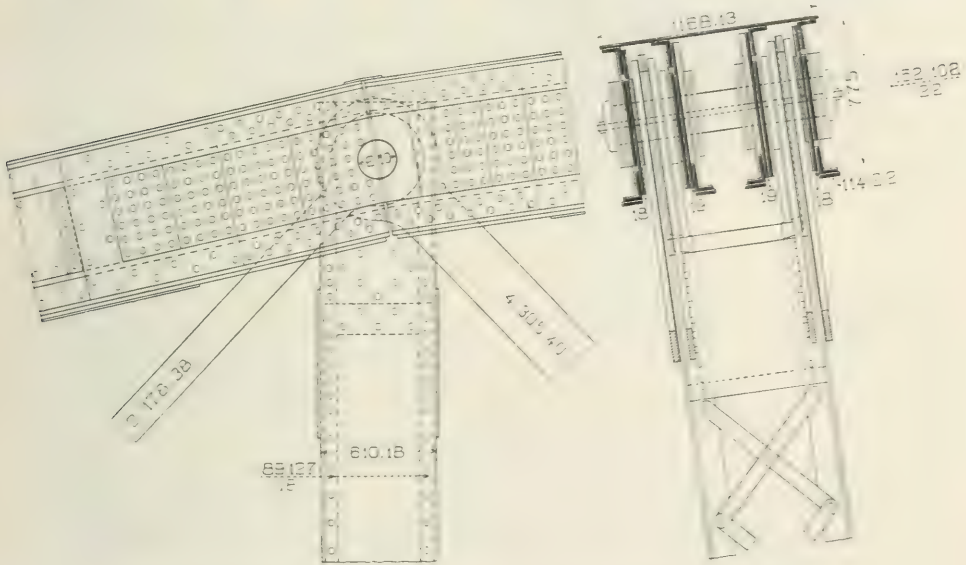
Obergurtknoten einer amerikanischen Fachwerksbrücke.
